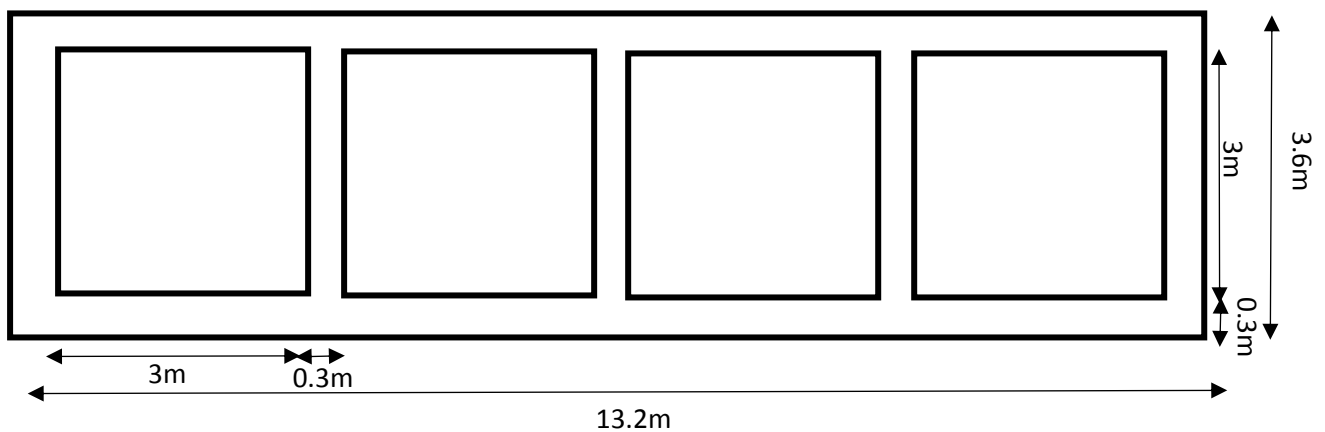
profile en travers des dalots de La route W133 tronçon B4
